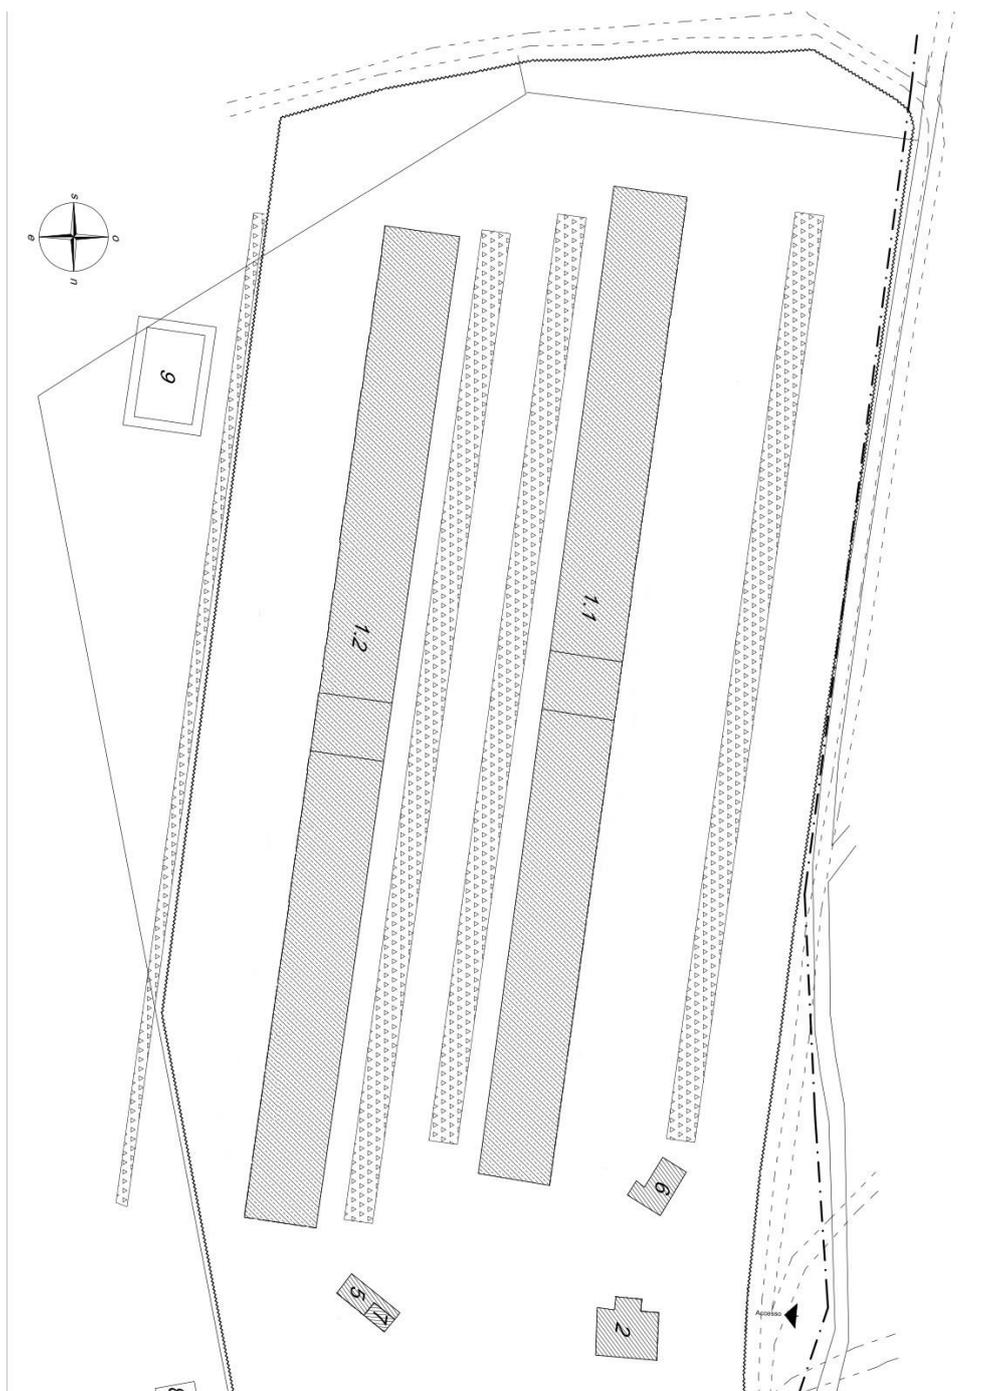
Planimetria dell'allevamento MORRO D'ORO (TE)
